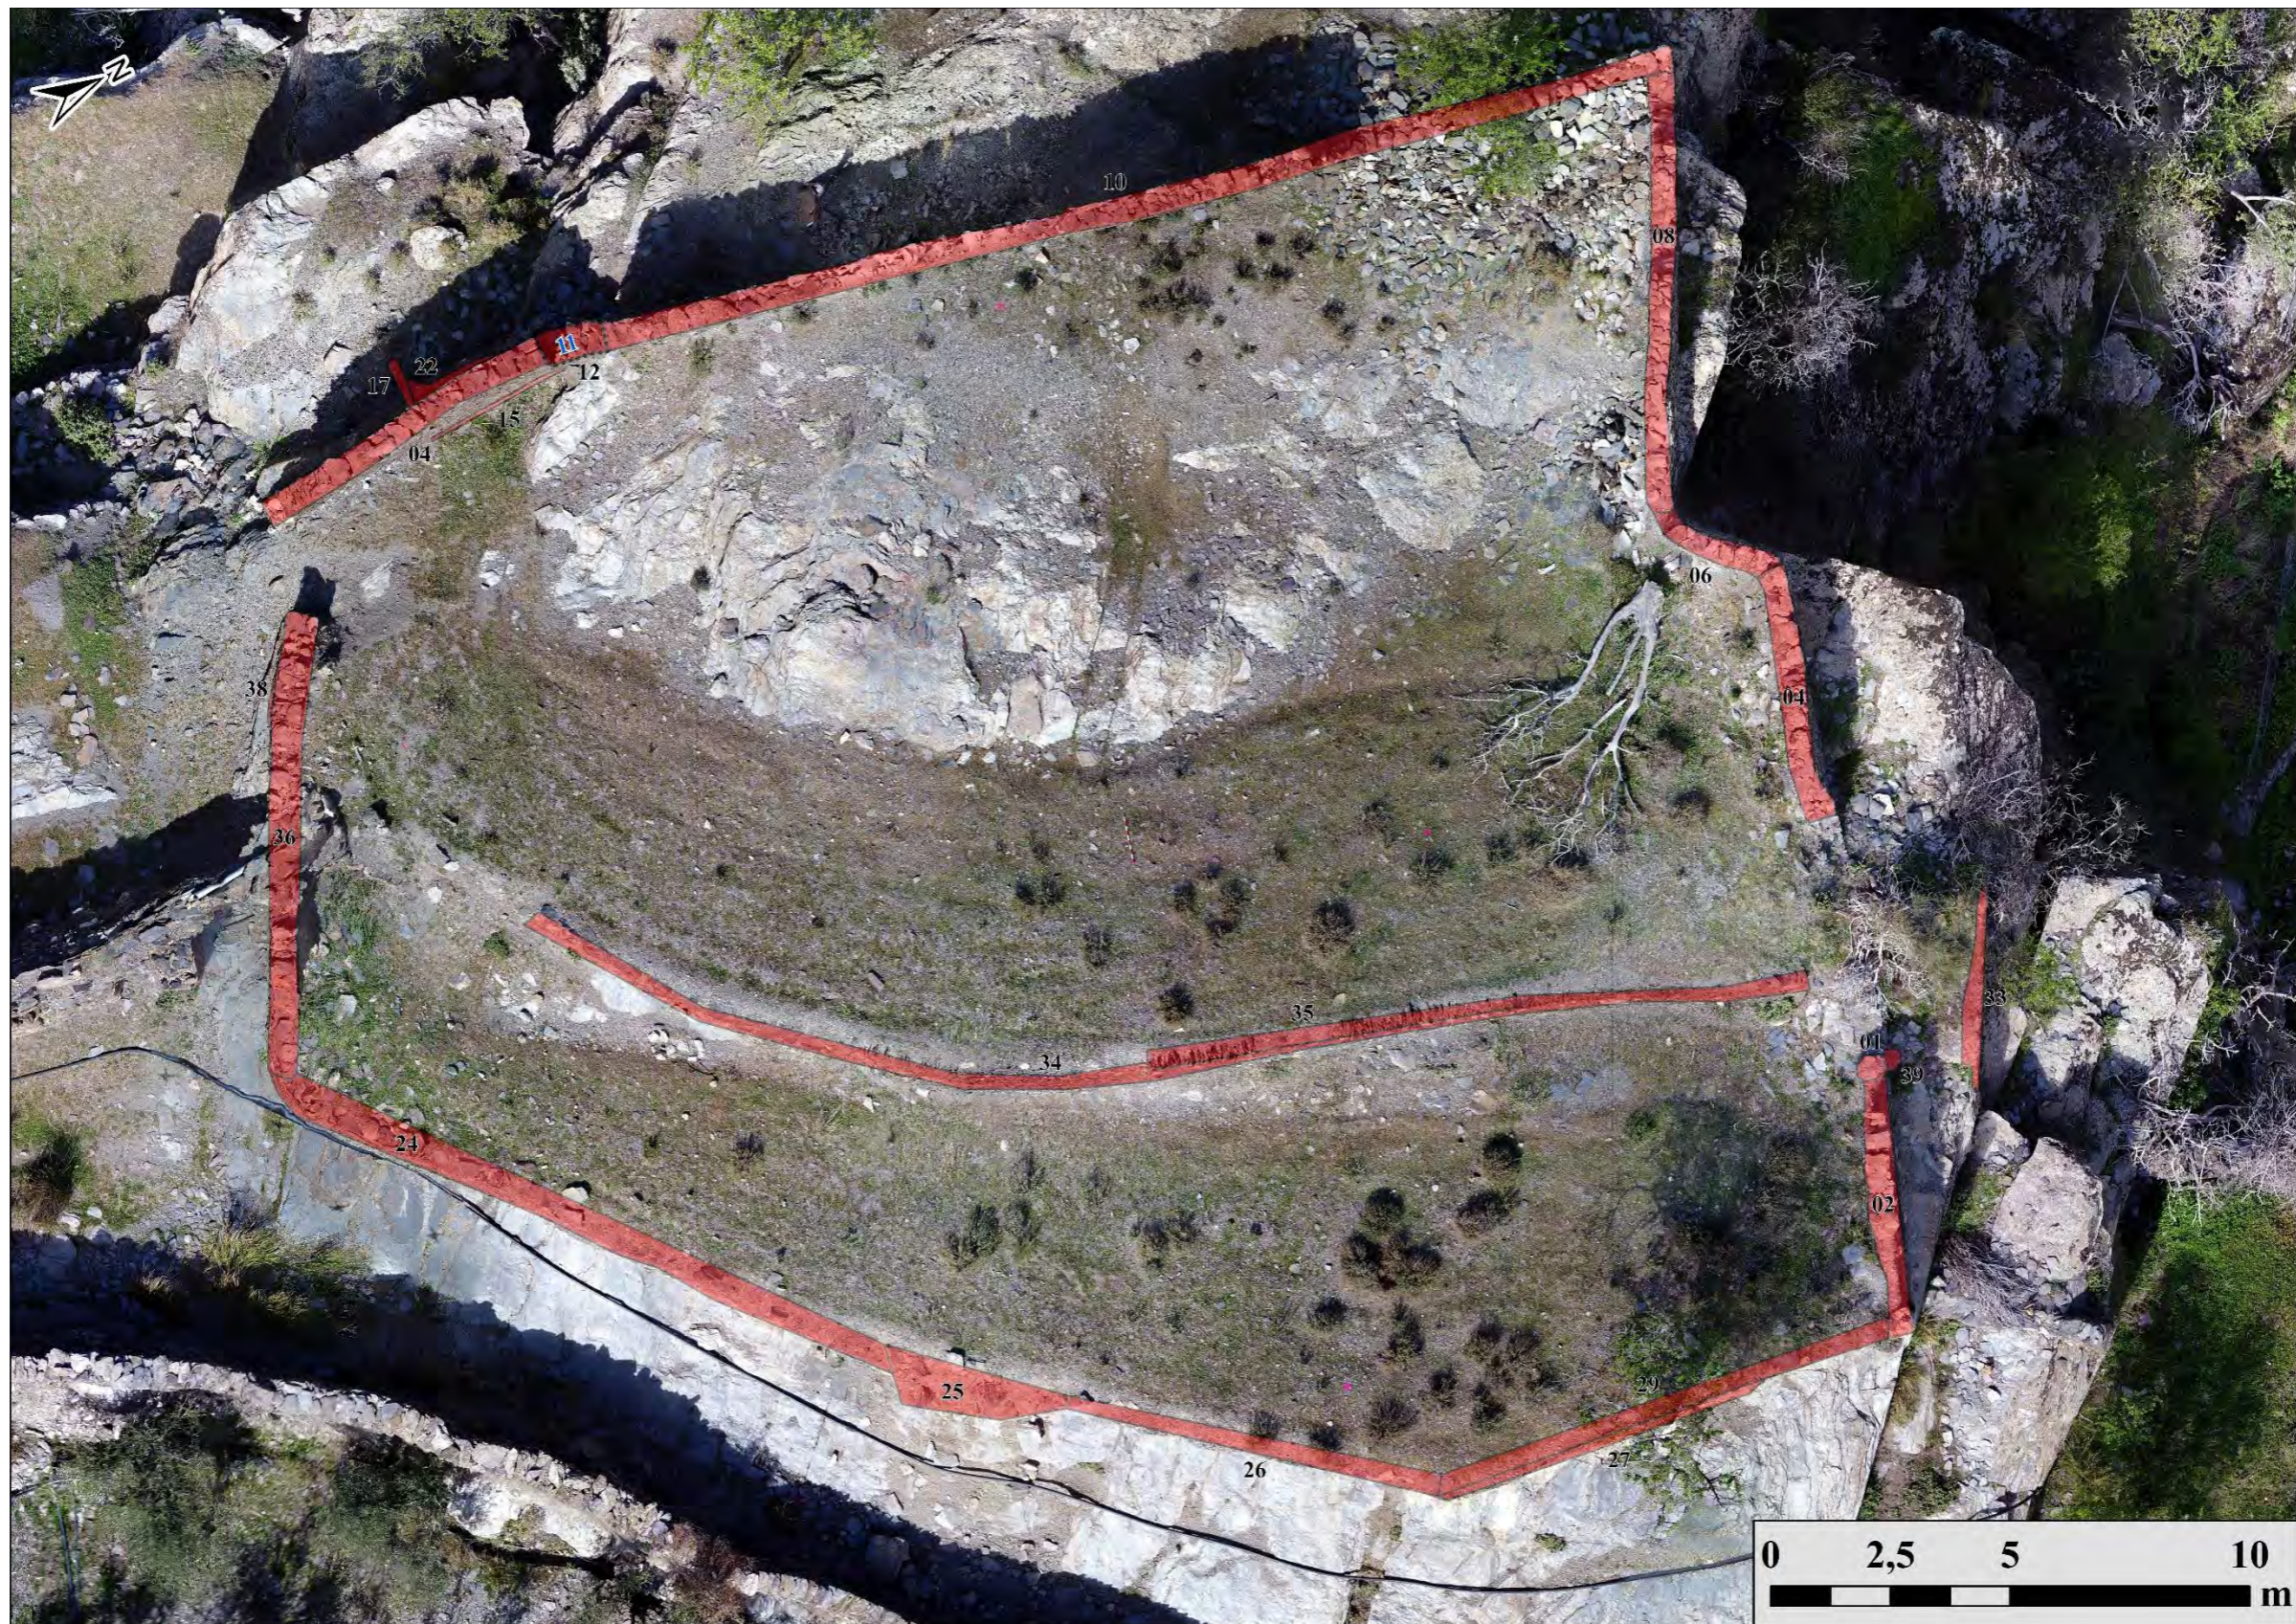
21: Planimetría de los restos construidos del castillejo de Ohanes.
